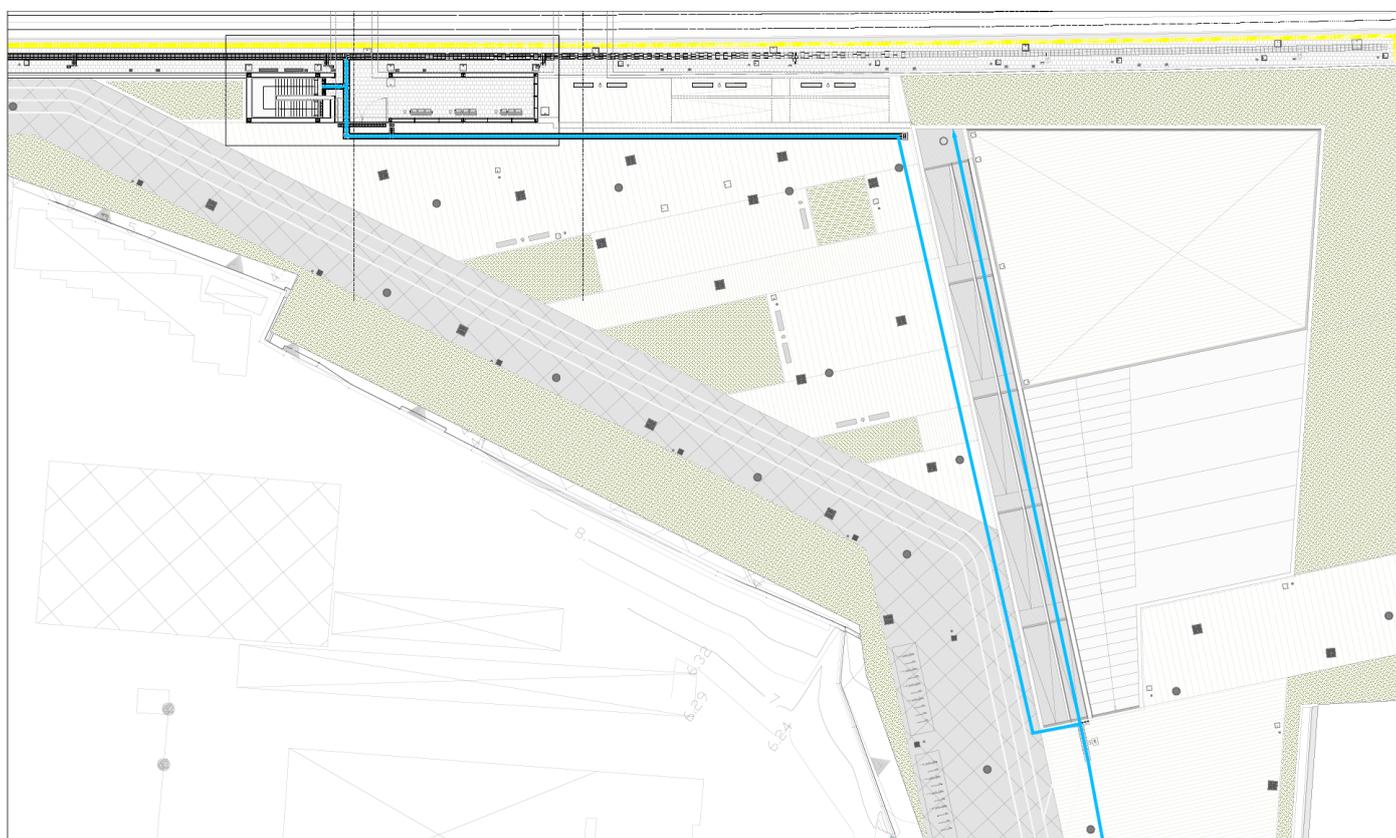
Pianta quota banchina con individuazione del PPO - Stralcio 1 di 2
